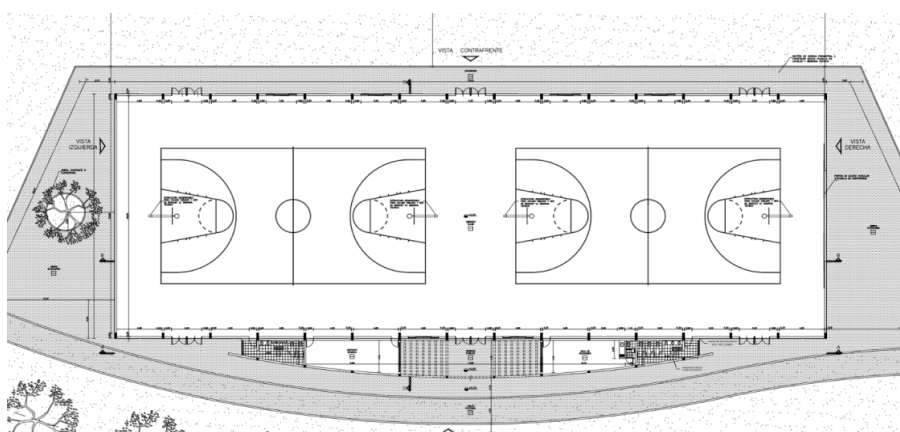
Planta de detalle del Gimnasio y Salón de Usos Múltiples.
